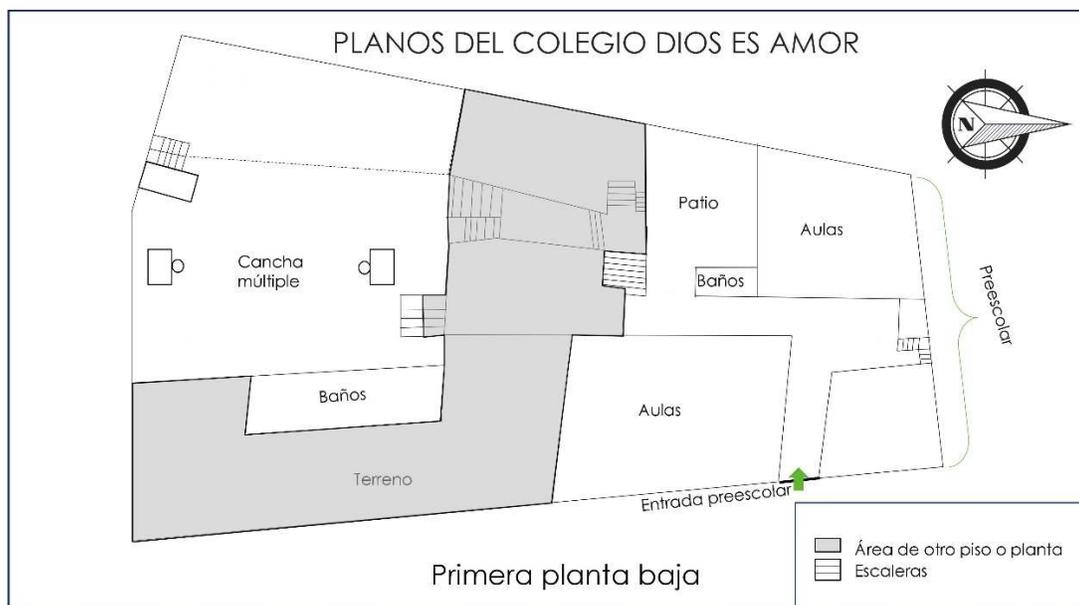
Plano 2: Primera planta baja. Fuente: IEEE, 2017.
